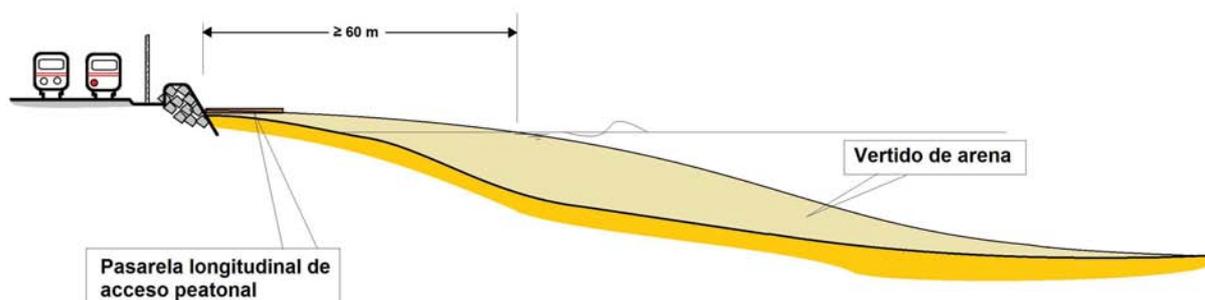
Concepto de las alternativas de actuación planteadas en este sector
